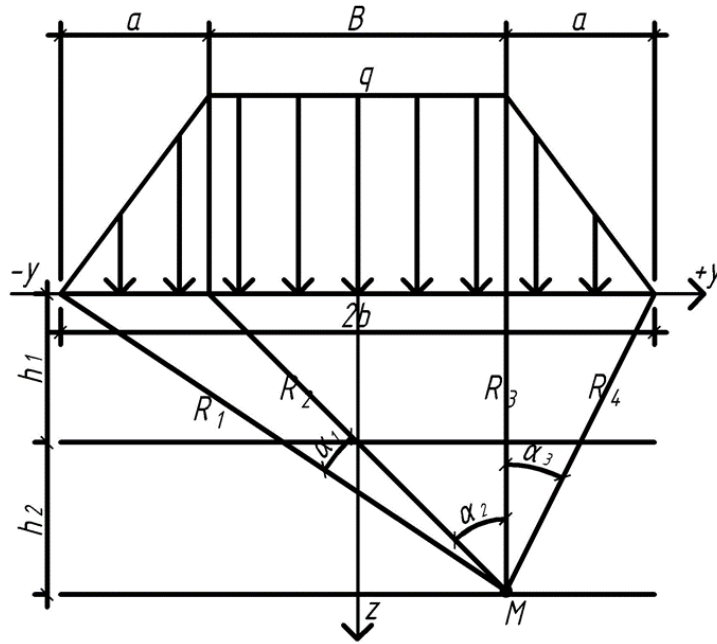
Расчетная схема для определения напряжений при трапецидальной нагрузке.
